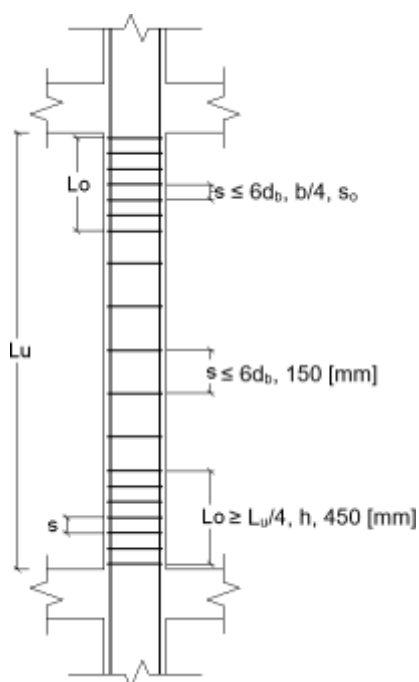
Disposición del refuerzo transversal en columnas. [Elaboración propia]
